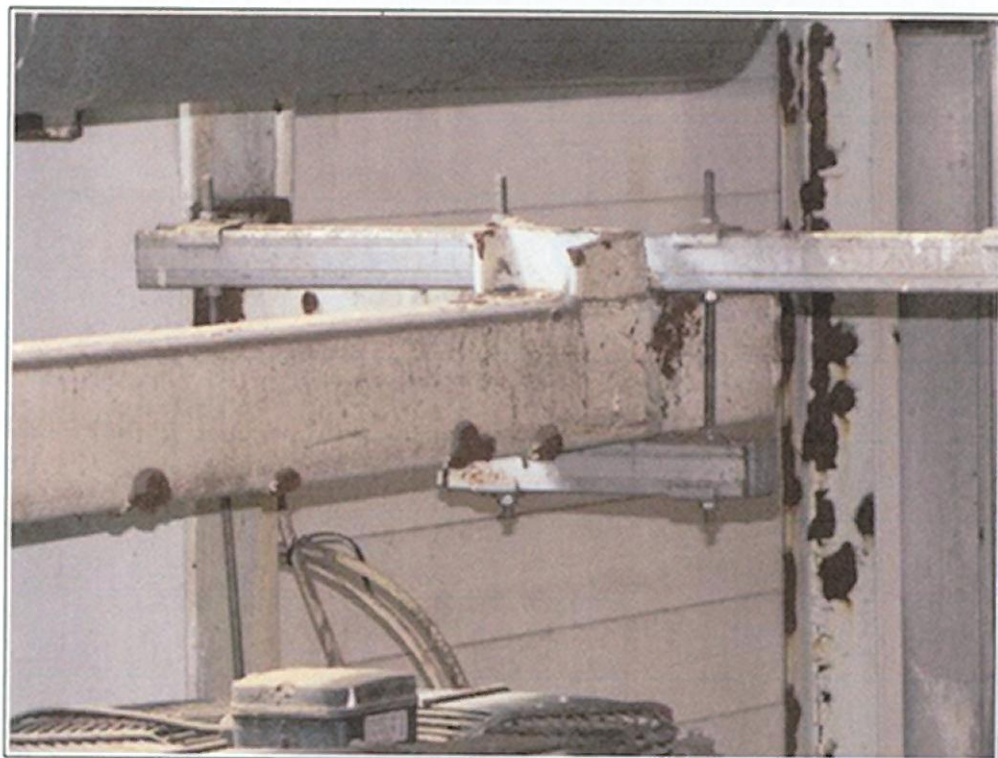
Hala (od B17) – Widok ogólny konstrukcji dachu z trasami kablowymi
